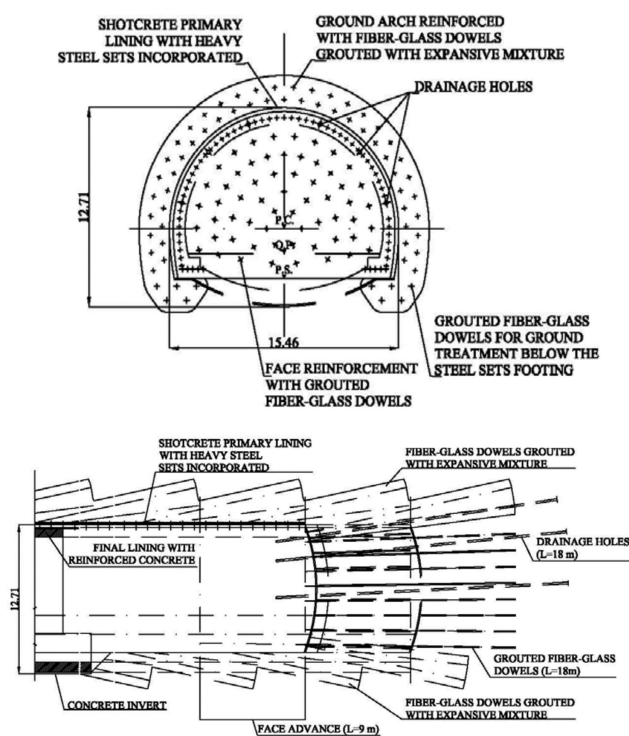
Tipico consolidamento del fronte utilizzato con lo scavo a piena sezione. Sezione trasversale e longitudinale rappresentati in modo schematico (fuori scala). Typical face reinforcement system used with the full face method. Cross section (above) and Longitudinal Section (below). Schematic drawings only, not to scale.
